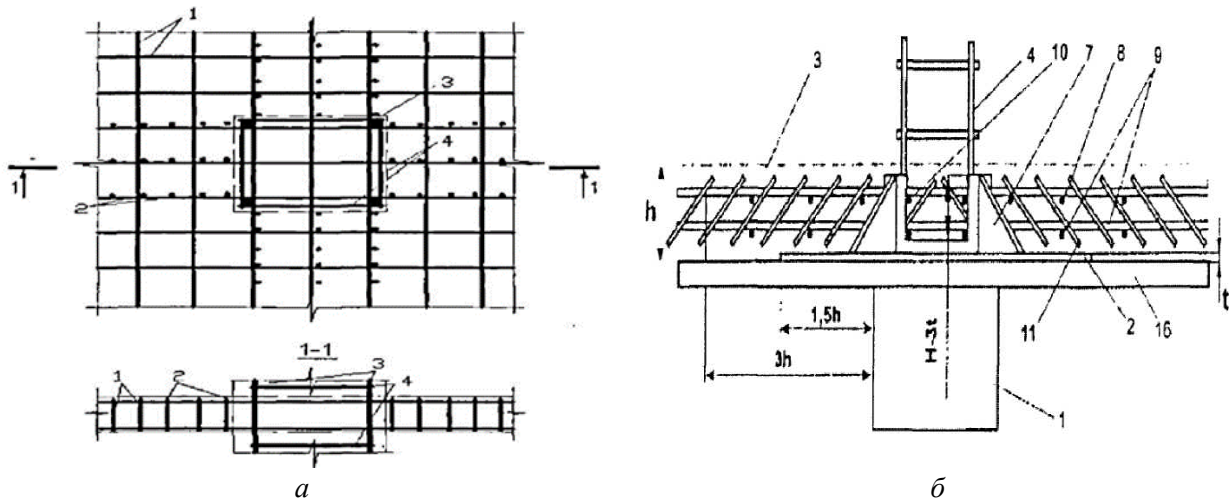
Арматування вузлового сполучення «плита-колона» поперечною арматурою:
